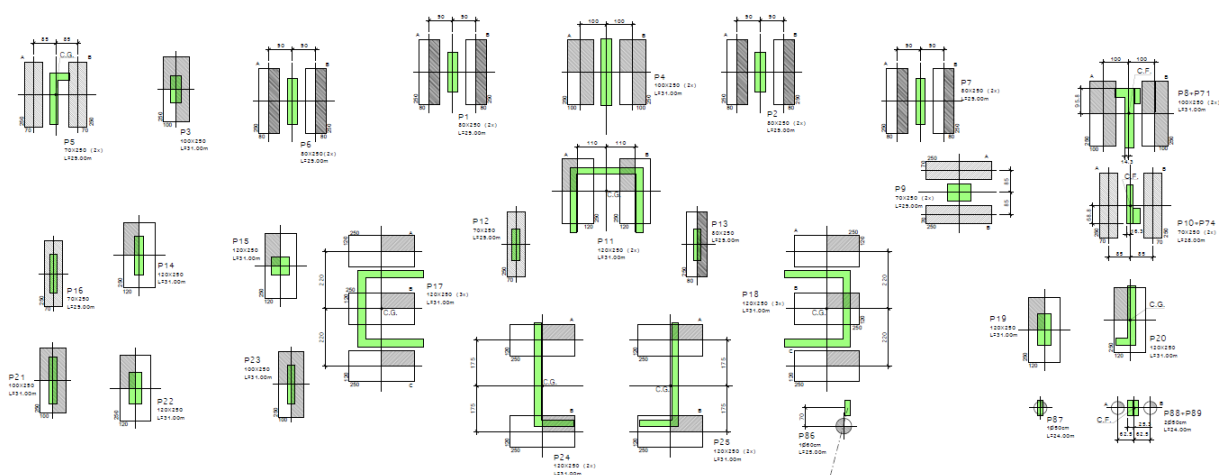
Projeto em estaca barrete Torre B (Autora, 2022)
